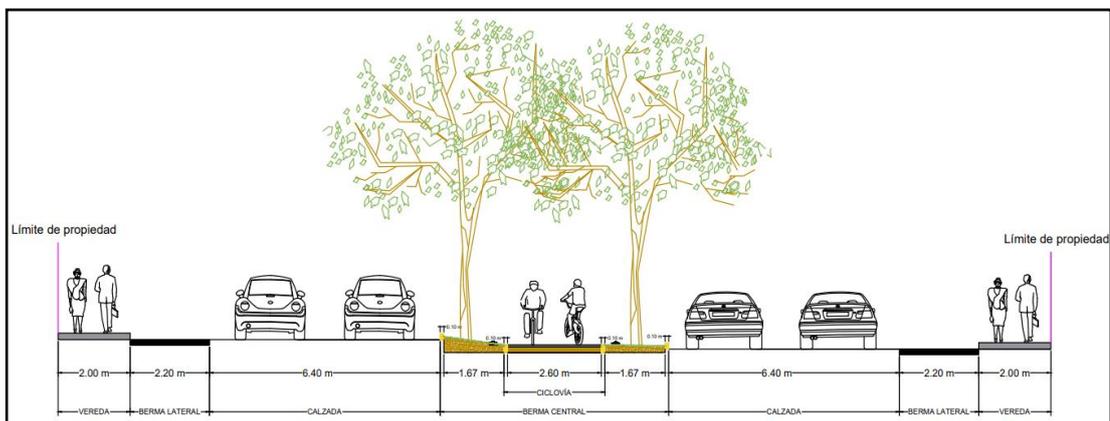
Propuesta de sección típica de la Av. Los Constructores con ciclovia.
